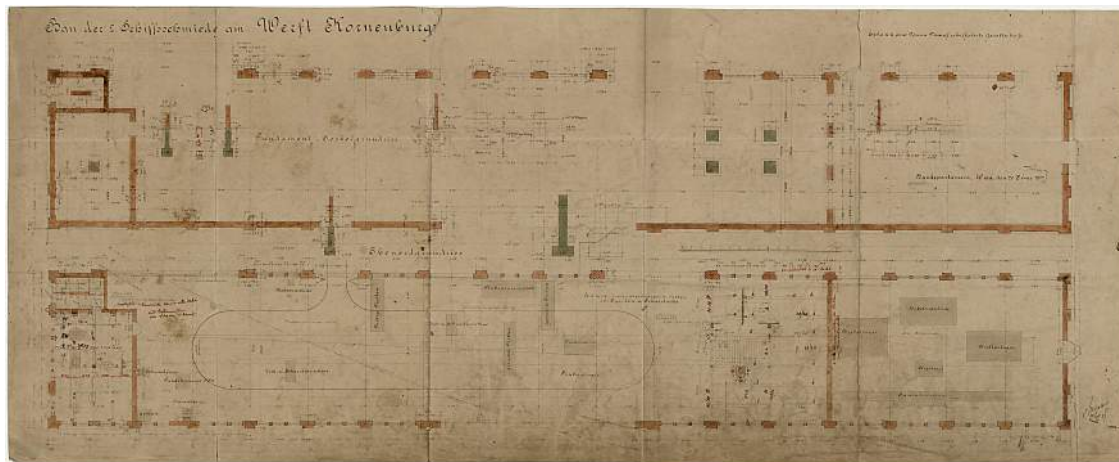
Plandarstellung des Fundament- sowie Ebenerdgrundrisses aus dem Jahr 1917
